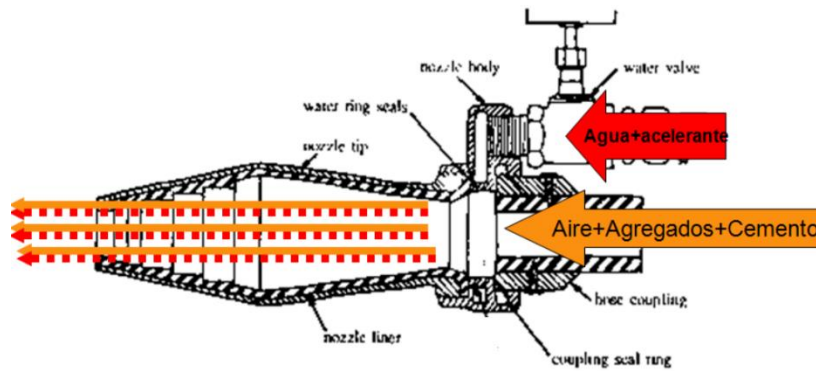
Mezclado en boquilla hormigón proyectado vía seca (BARREDA GONZALES, 2014)
